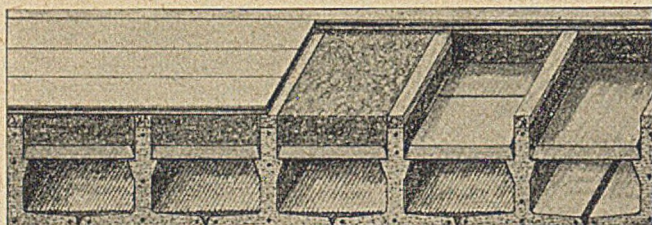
Stahlstrebenbeton-T-Trägerdecke nach Müllpo.
